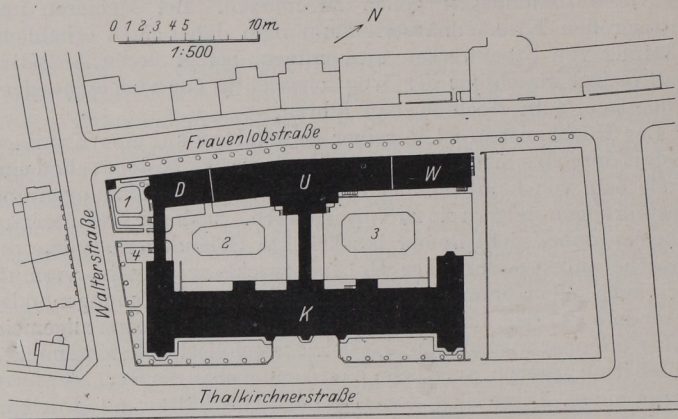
Lageplan der Bauanlage der dritten medizinischen (dermatologischen) Abteilung des städt. Krankenhauses l. d. Isar in München.
